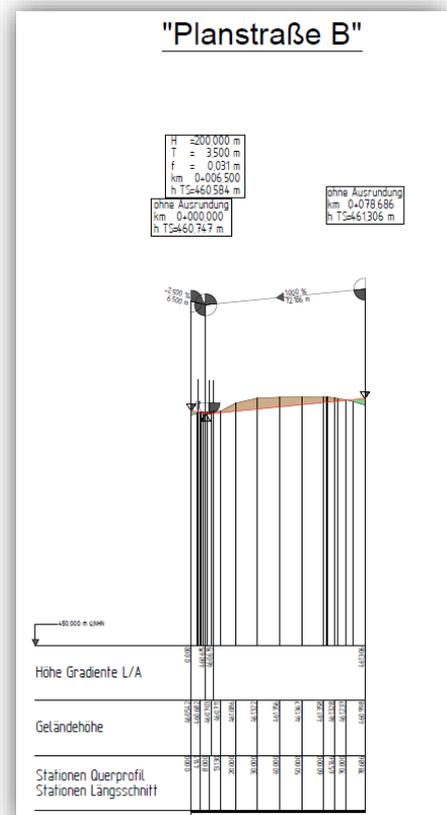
Höhenplan Planstraße B Baugebiet „Am Schloss“
